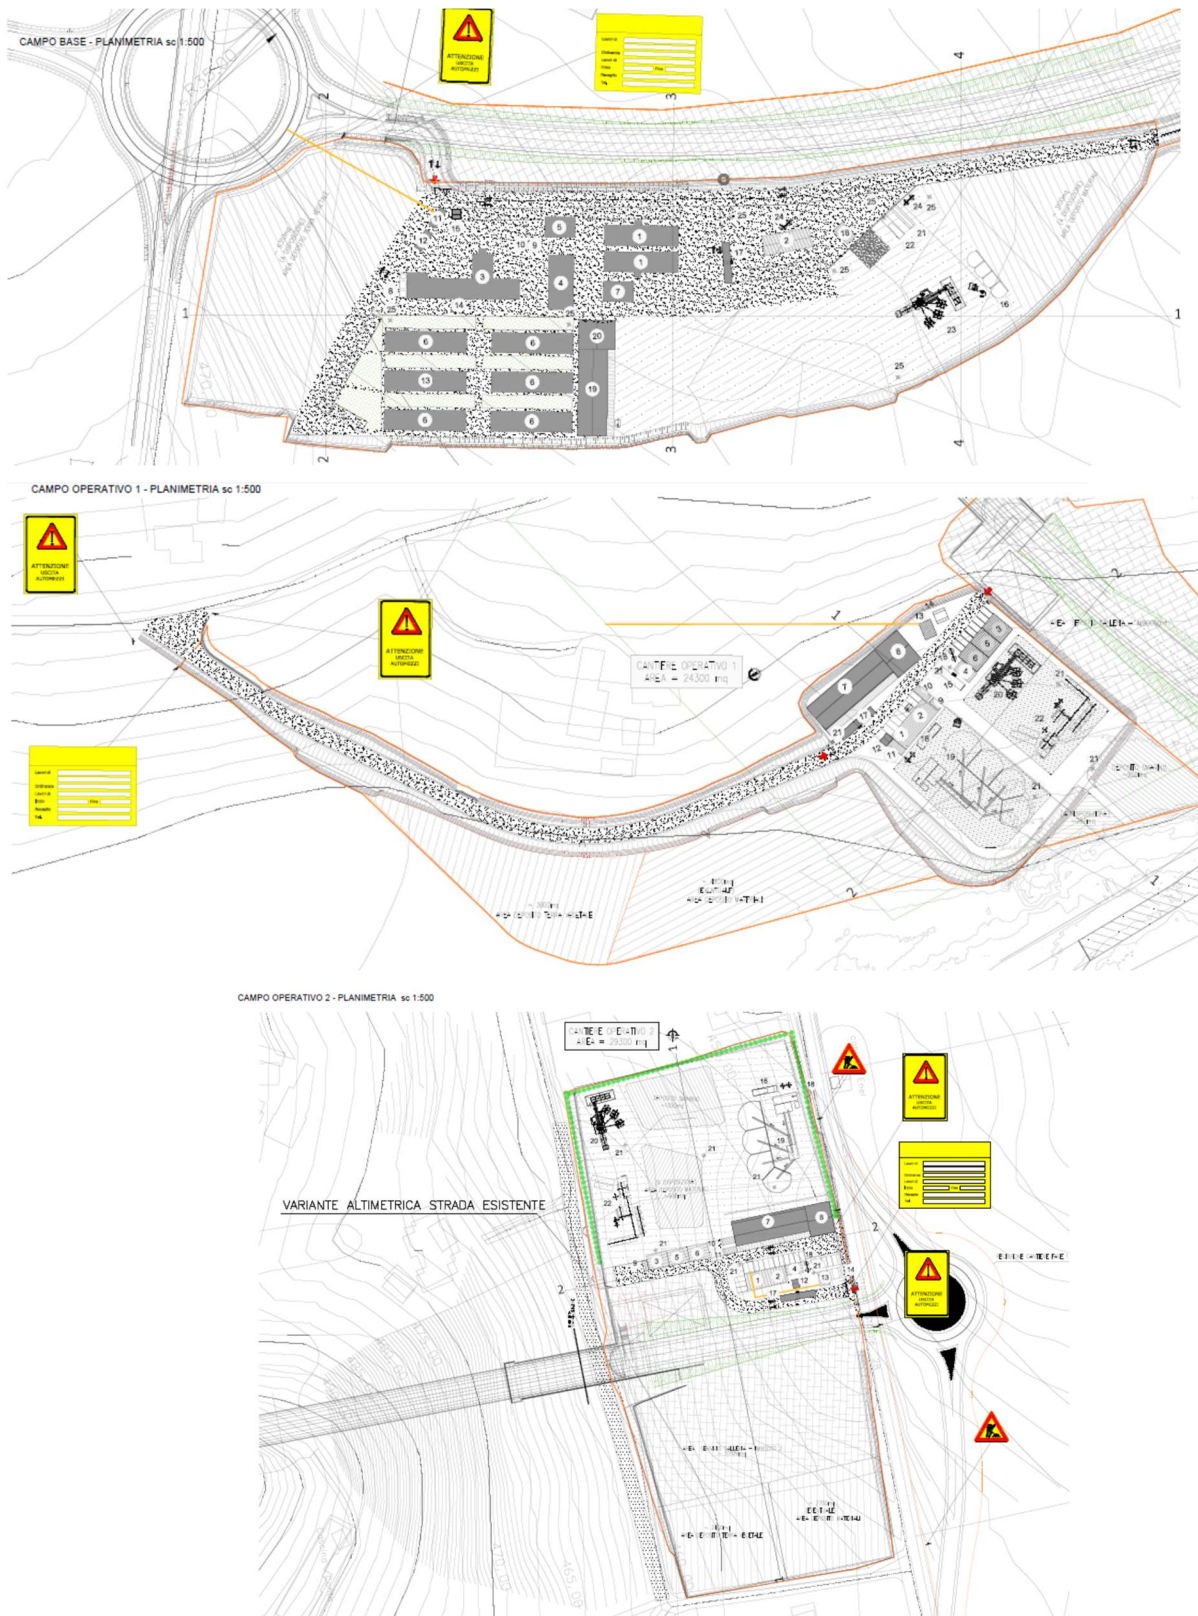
Asse principale: layout cantiere base e cantieri operativi 1 e 2
